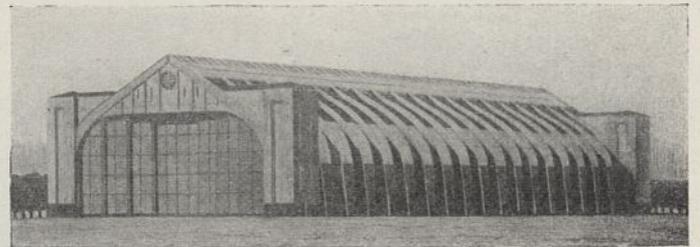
Zweischiffige Bauhalle in Eisenbeton.
